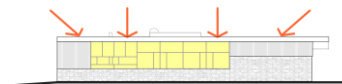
Ingreso del sol por la fachada Oeste. Fuente: Autor.
